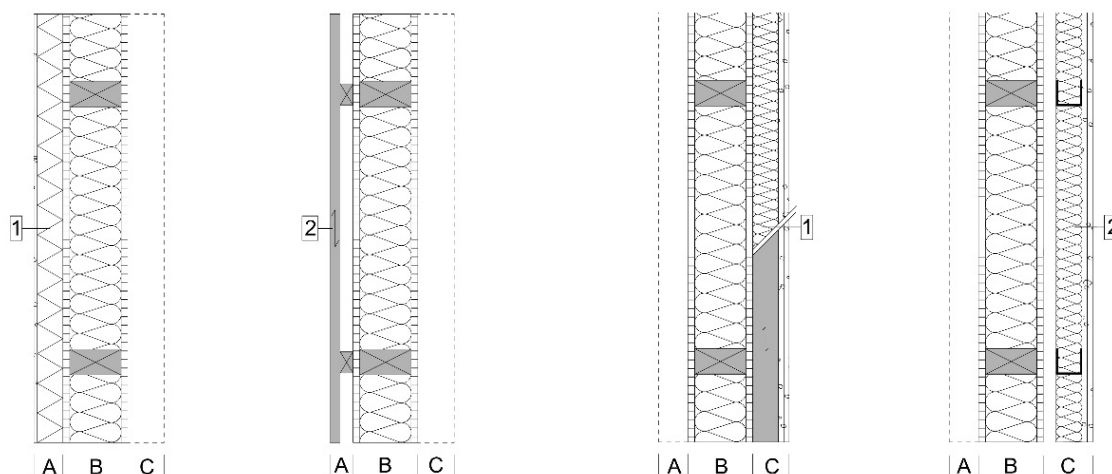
Wandaufbauten im Horizontalschnitt (Eigene Darstellung)
